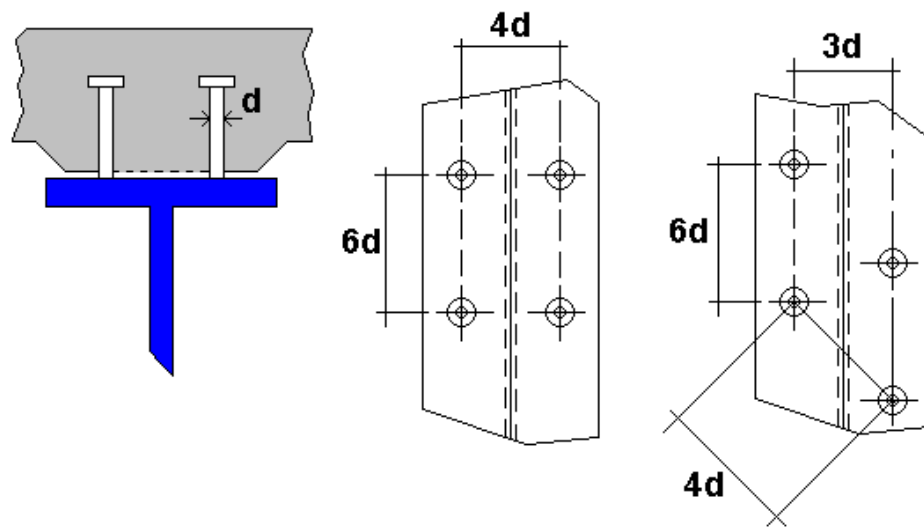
Arreglo de los conectores tipo espárrago (Ref. 3)
